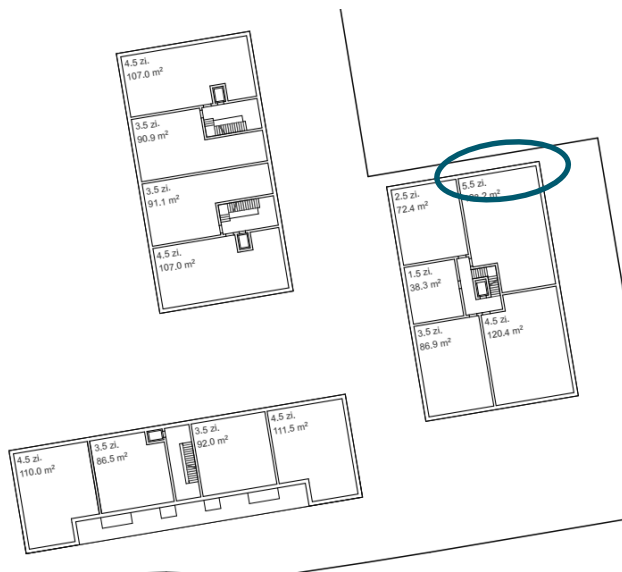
Grundriss Wohnungen im Obergeschoss
